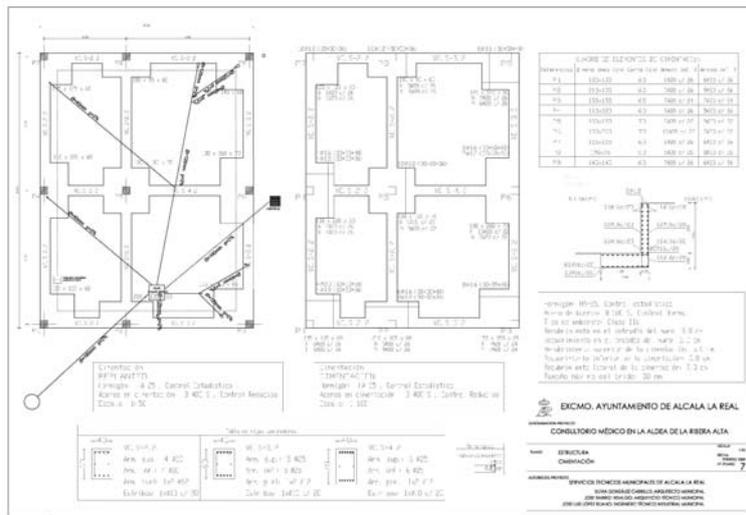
Planta de replanteo de los pilares del consultorio médico
